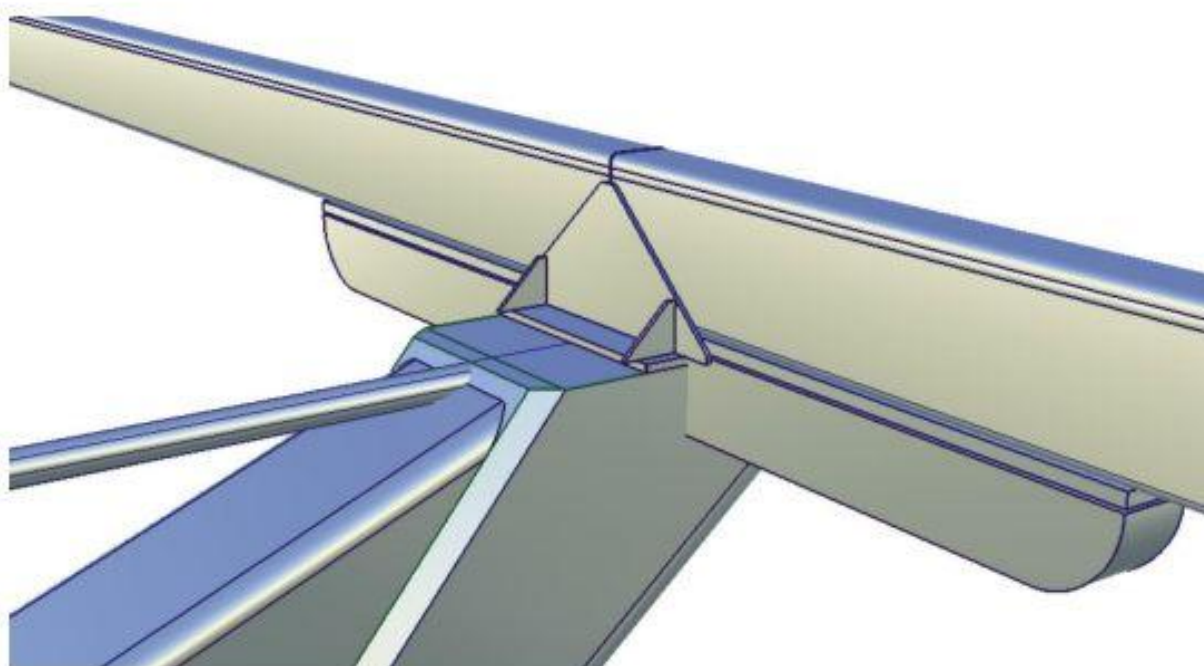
Внешний вид опорного узла (вид изнутри пути СТЮ).
